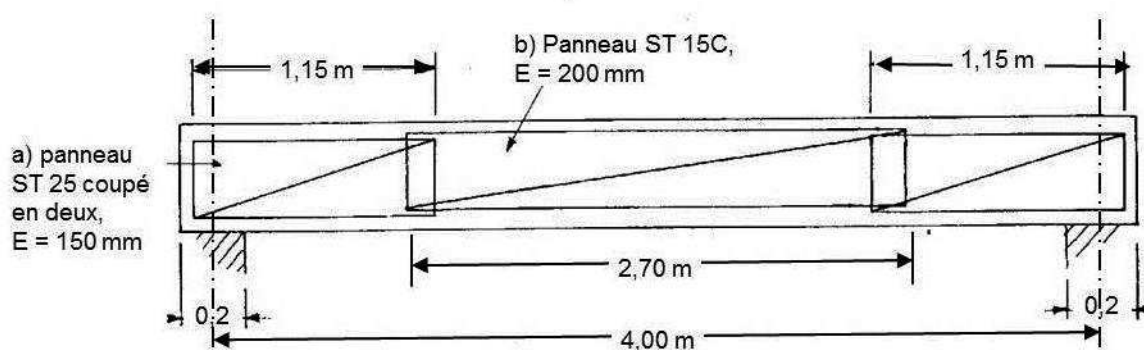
Ferrailage de poutre au moyen de panneaux en treillis soudé.
